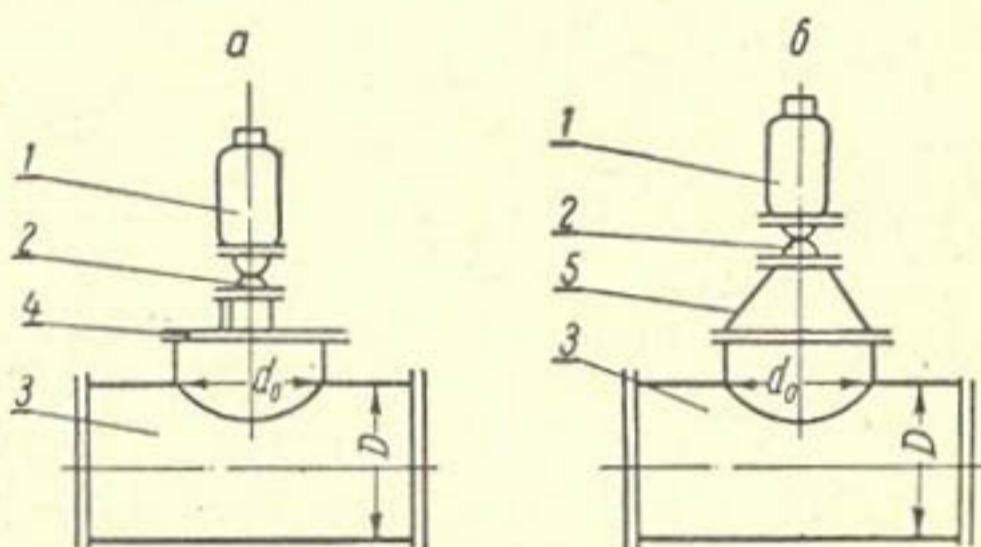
Схема установки вантузов на подземных трубопроводах:
